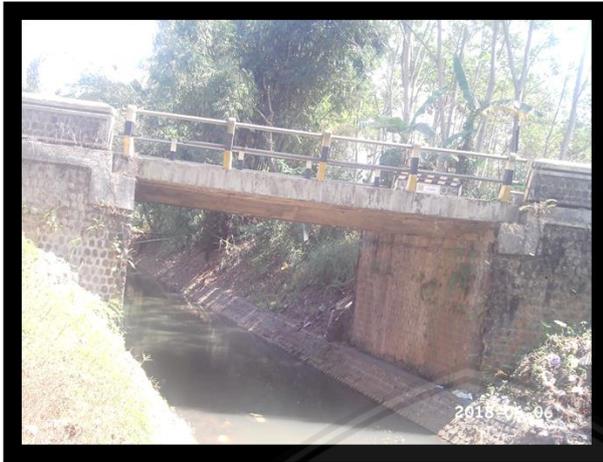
Dokumentasi bangunan lantai bendung
